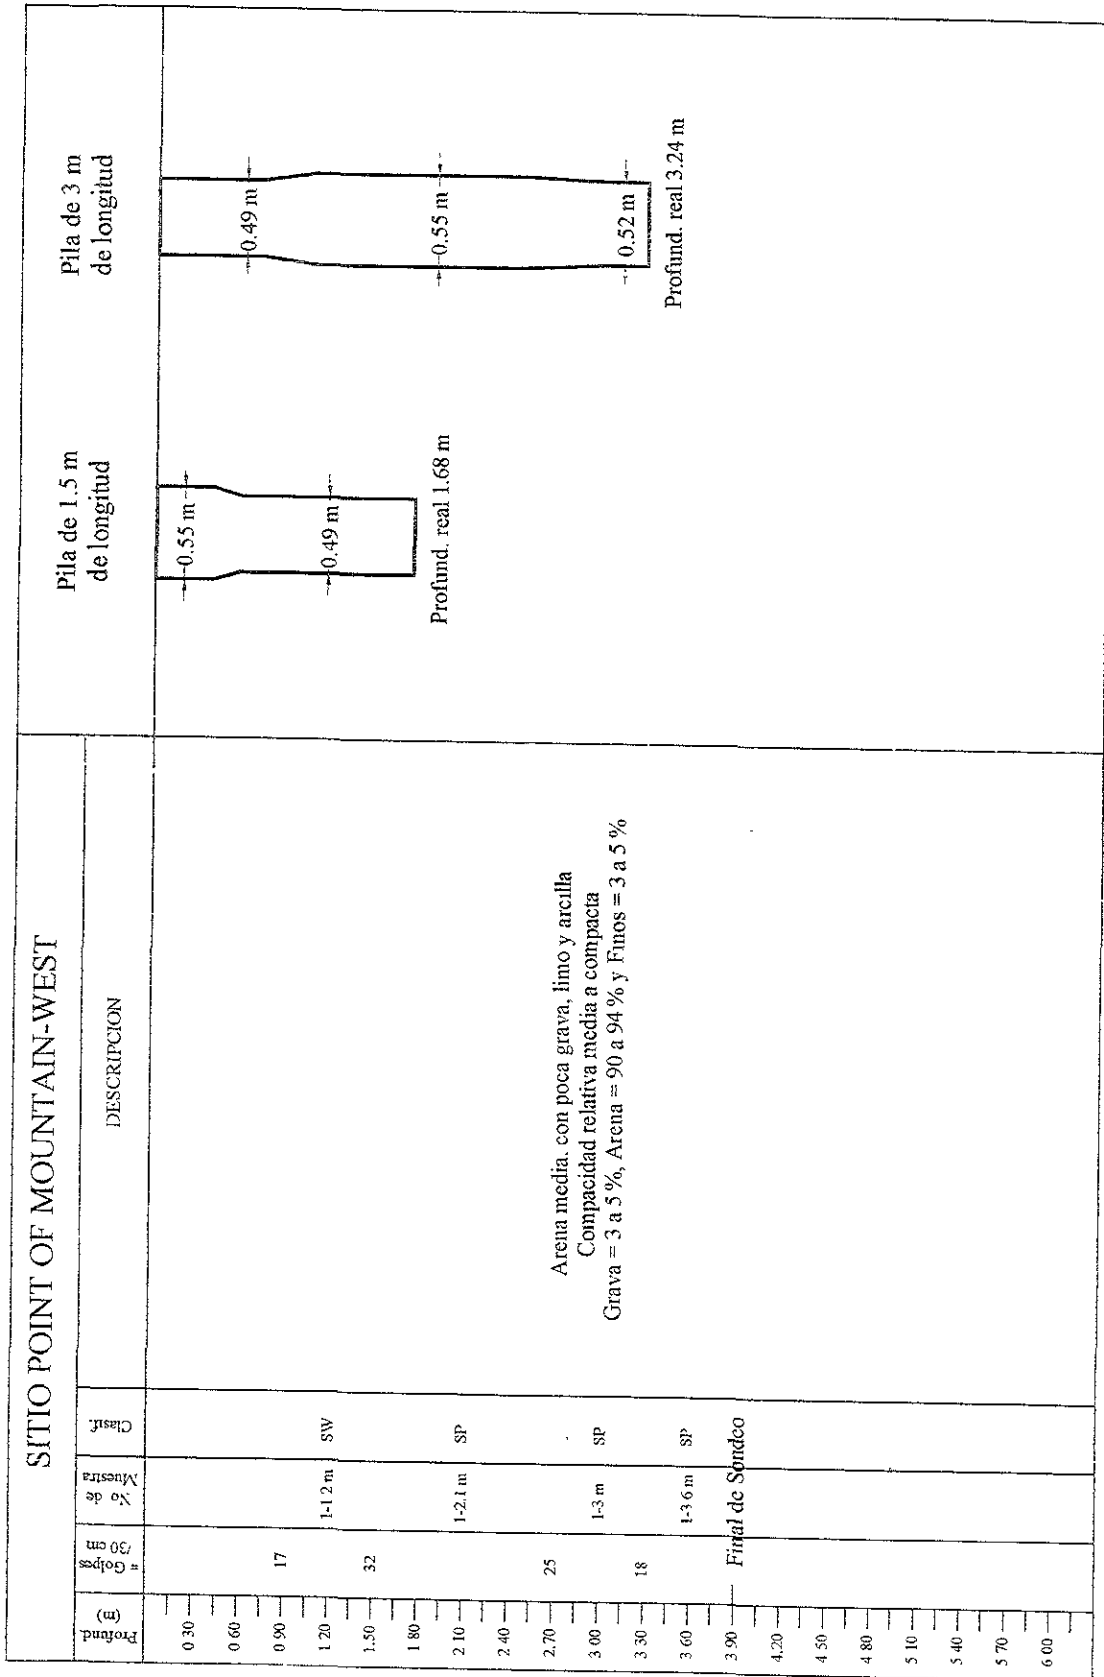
Perfil estratigráfico y geometría de las pilas en el Sitio Point of Mountain-West (adaptado de Golder (2000))
